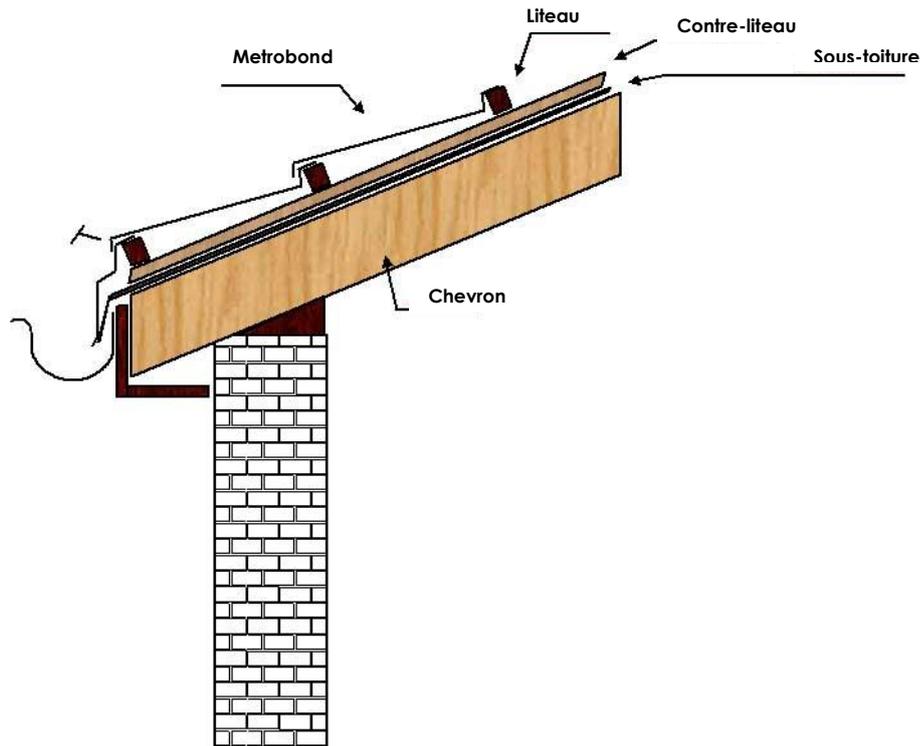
b : pied de versant + profilé de départ Metrotile Shingle
